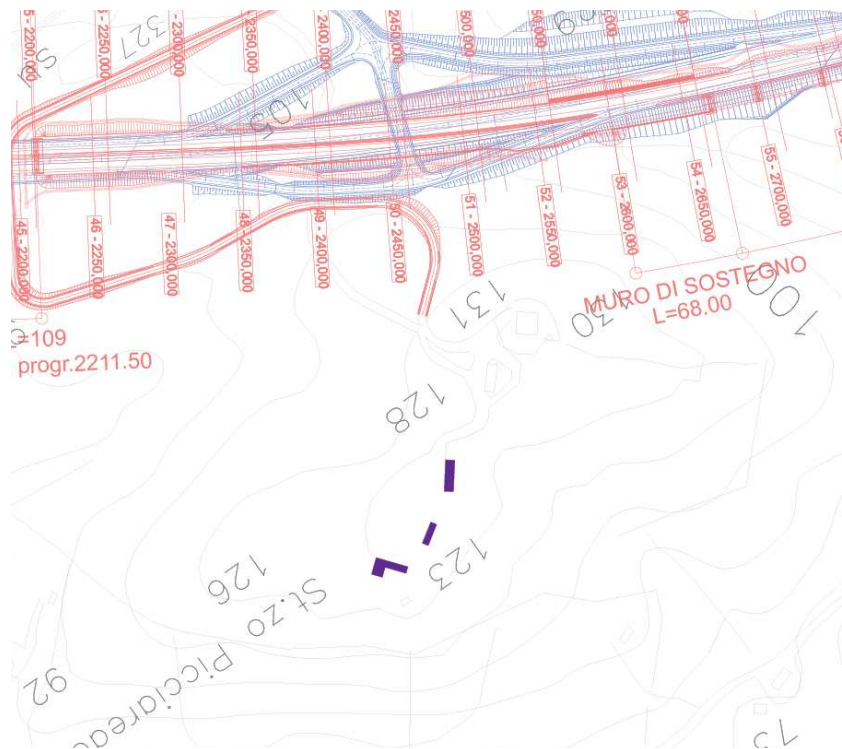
Localizzazione stazzo Picciaredda rispetto ai tracciati
